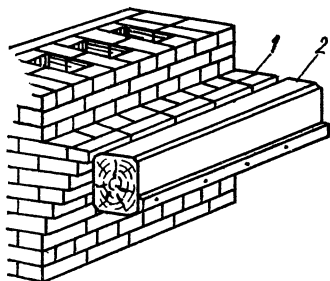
Разделка между стеной с каналом и деревянной балкой:
